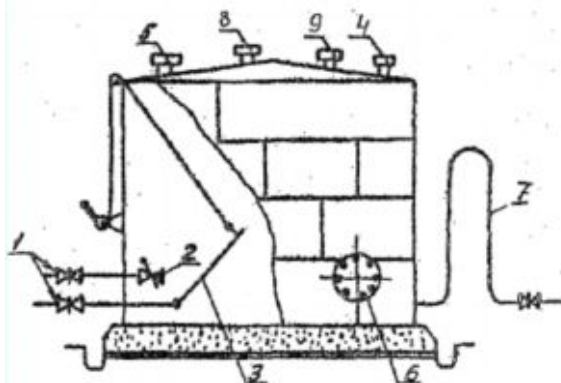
Схема расположения оборудования на наземном вертикальном цилиндрическом стальном резервуаре: 1 — световой люк; 2 - вентиляционный патрубок; 3 - огневой предохранитель; 4 — дыхательный клапан; 5 — замерной люк; 6 - указатель уровня; 7 - люк-лаз; 8 - сифонный клапан; 9 — хлопушка; 10 - приёмо-раздаточные патрубки; 11 - перепускное устройство; 12 - управление хлопушкой; 13 - лебёдка; 14 - подъёмная труба; 15 - шарнир подъёмной трубы; 16 -роликовый блок
